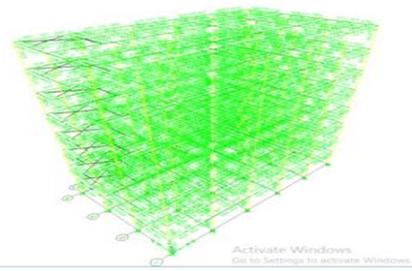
Denah Rencana Gedung dengan Bracing tipe X
